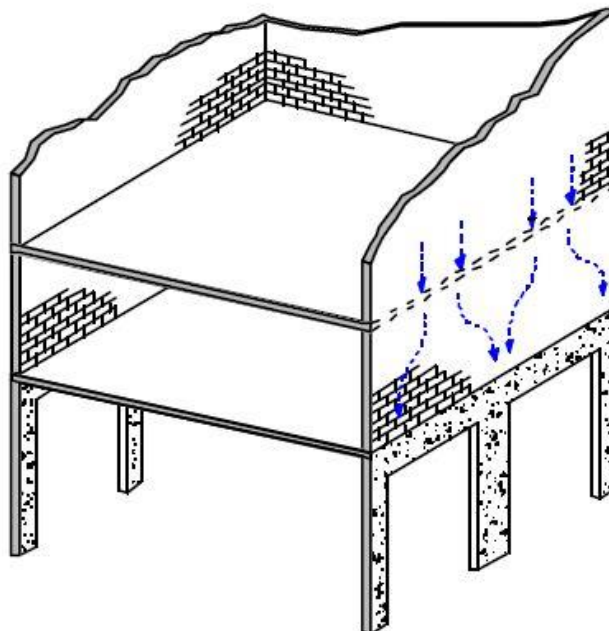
Edifício em alvenaria estrutural sobre pilotis em concreto armado (BARBOSA, 2000)
